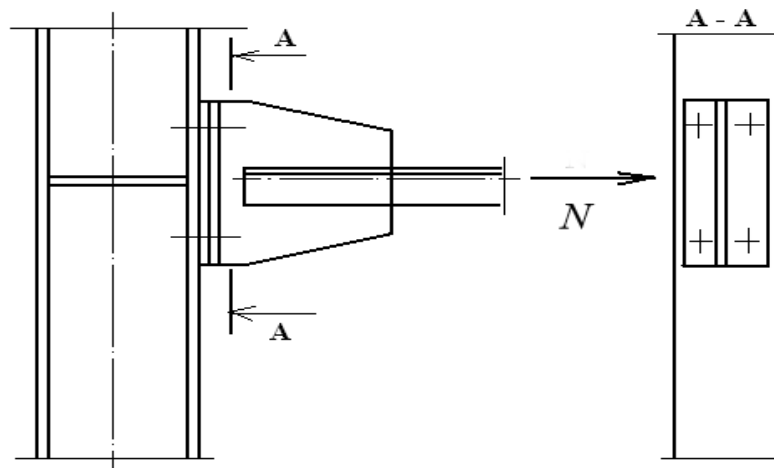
Схематичное изображение соединения верхнего пояса стропильной фермы к колонне к примеру 2
